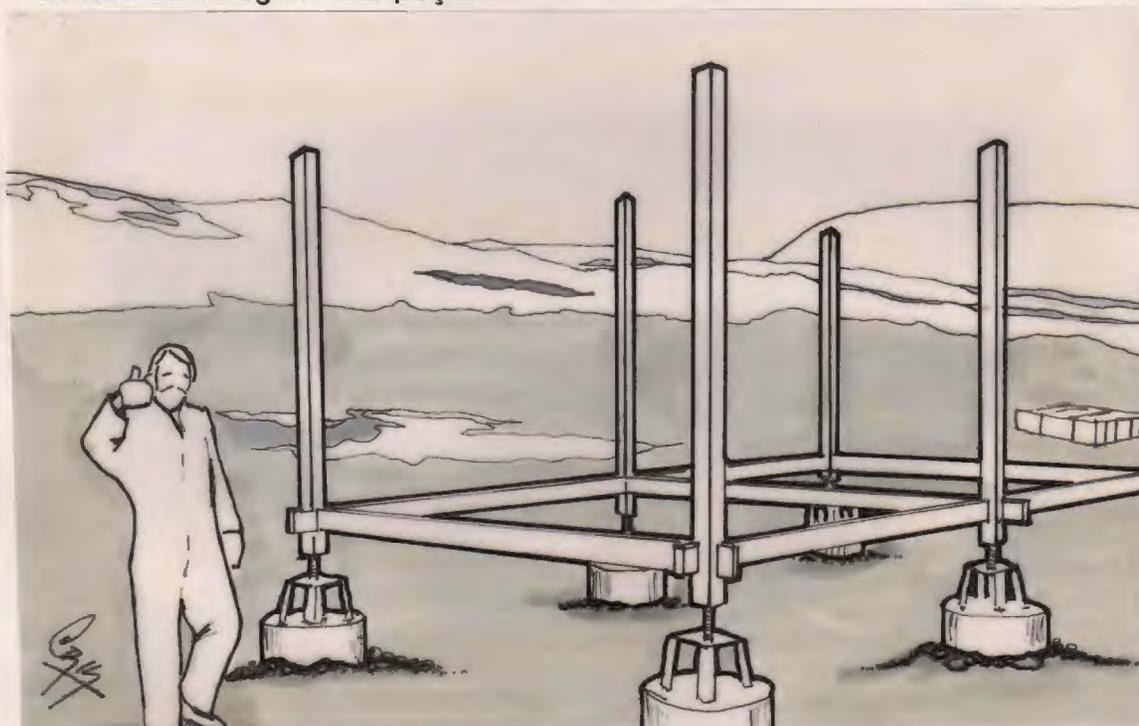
Montagem da estrutura principal: sapatas, vigas inferiores e pilares. As vigas superiores, que dão a amarração final na edificação, são posicionadas após a colocação dos painéis laterais.
